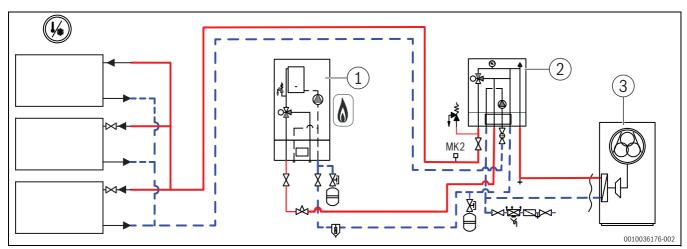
Schéma hydraulique d'une installation (1 circuit de chauffage, sans by-pass; exemple)
